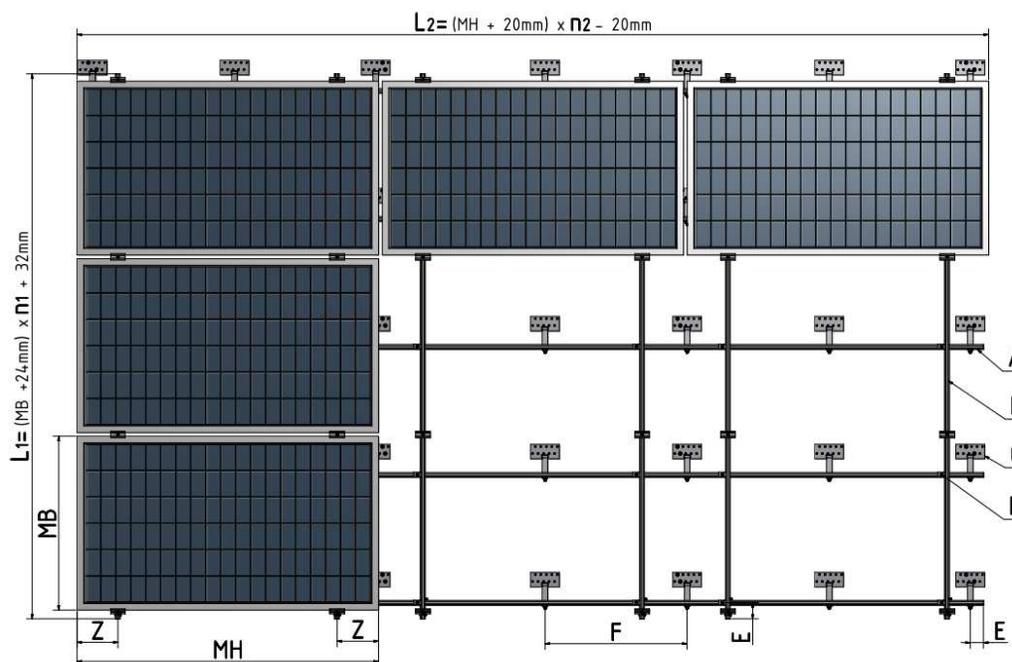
Dachhakenverbinder und Trägerprofil im Gesamtbild
